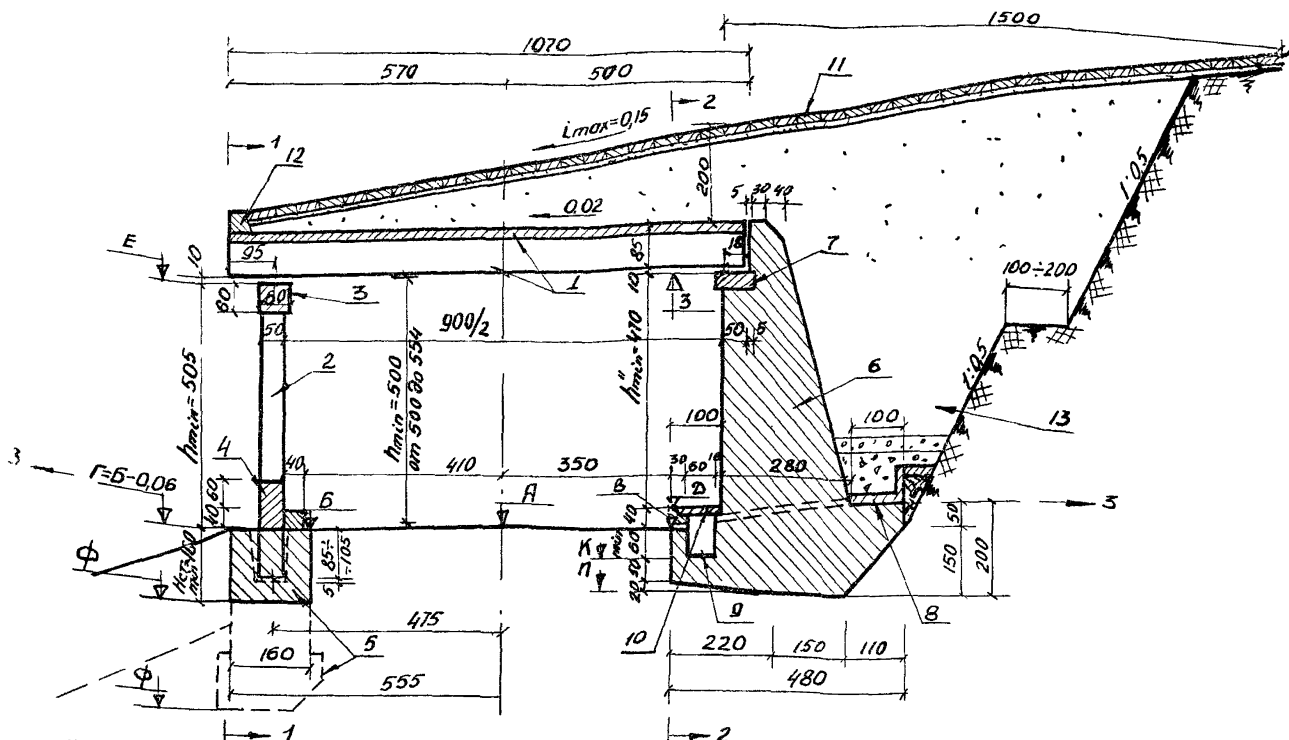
Поперечный разрез участка галереи, расположенного на прямой в плане: 1-Г-образный х.б. блок перекрытия; 2-х.б. стойка сечением 50x50 см; 3-х.б. двухконсольная насадка; 4-бетонный парапет между стойками; 5-бетонный фундамент-низовая подпорная стена; 6-верховая опора галереи-верховая бетонная стена; 7-х.б. опорная подушка; 8-дренажный лоток; 9-оросительная канава; 10-х.б. плита; 11-укрепление бетонными плитами 49x49x8 см на гравии $\rho_1 = 10$ см по всей длине галереи на ширину 25 м; 12-карниз; 13-засыпка
